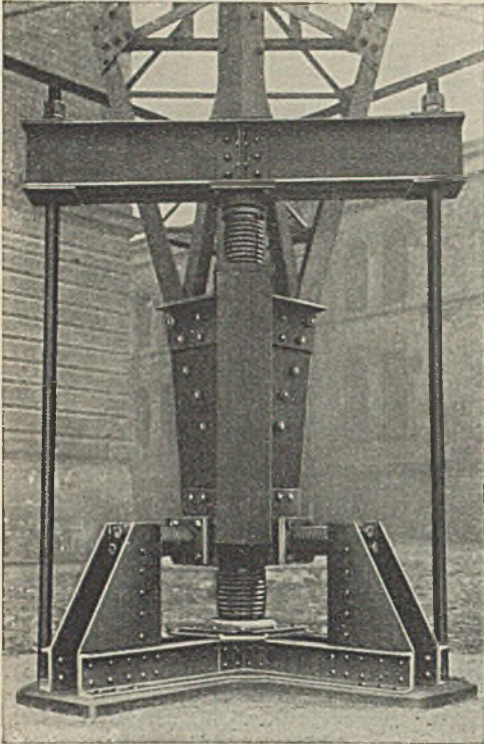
Fußisolierung und -verankerung freistehender Funktürme in Stuttgart.
